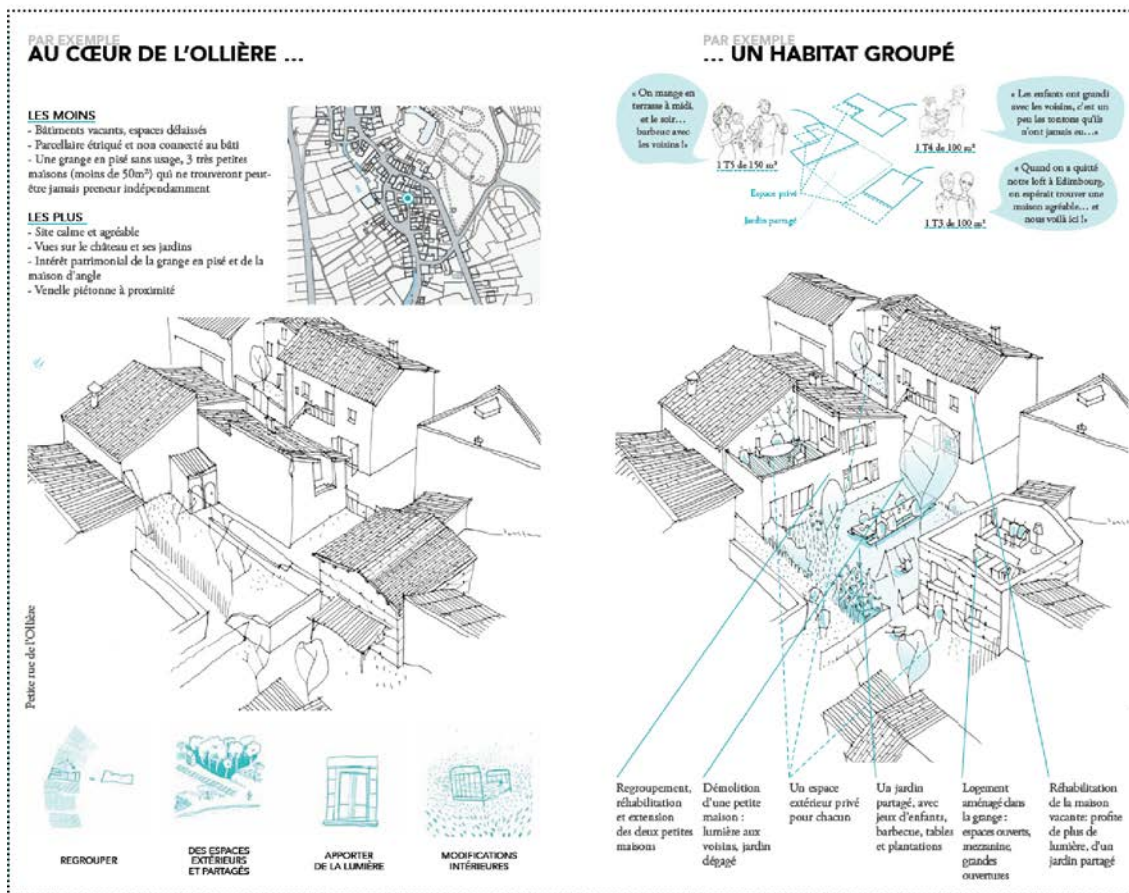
Exemple de proposition de remodelage urbain faite par le collectif ETC pour le village de Châteldon. Auteur : Collectif ETC.
